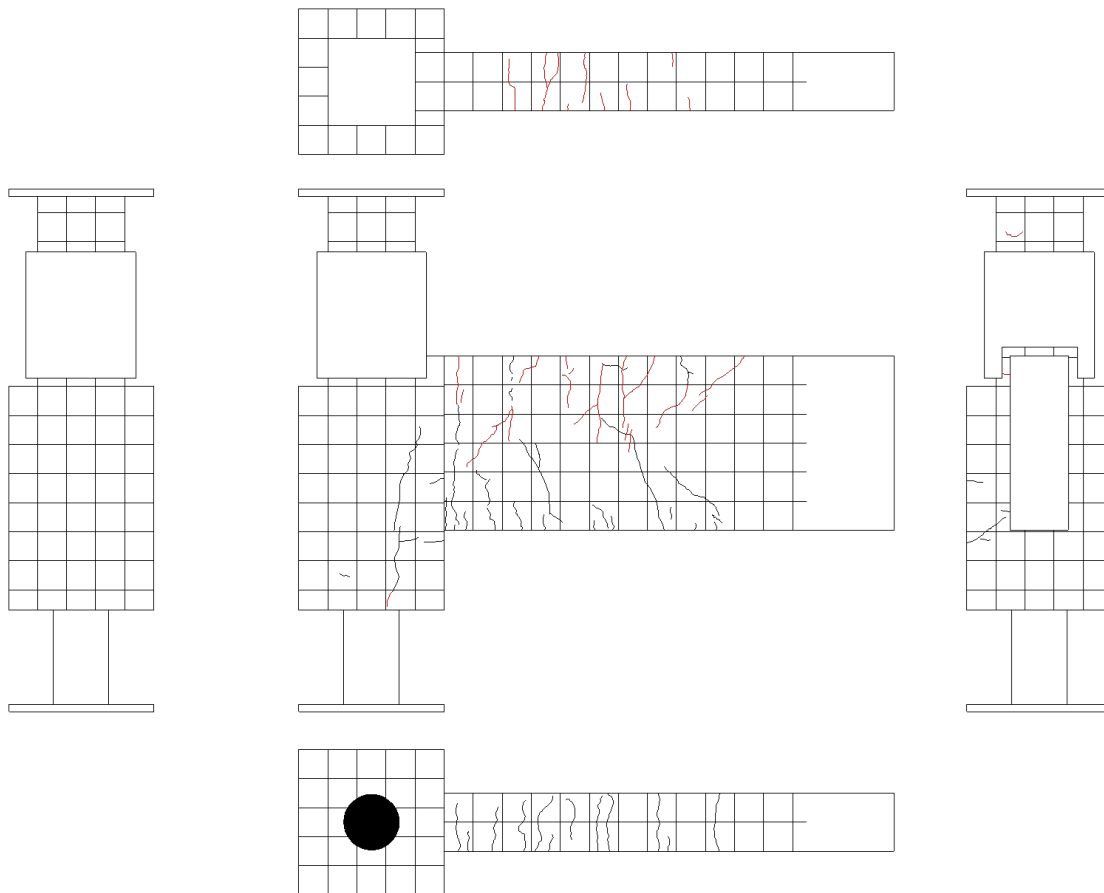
試験体 A-1 ひび割れ状況 (1Cycle)
